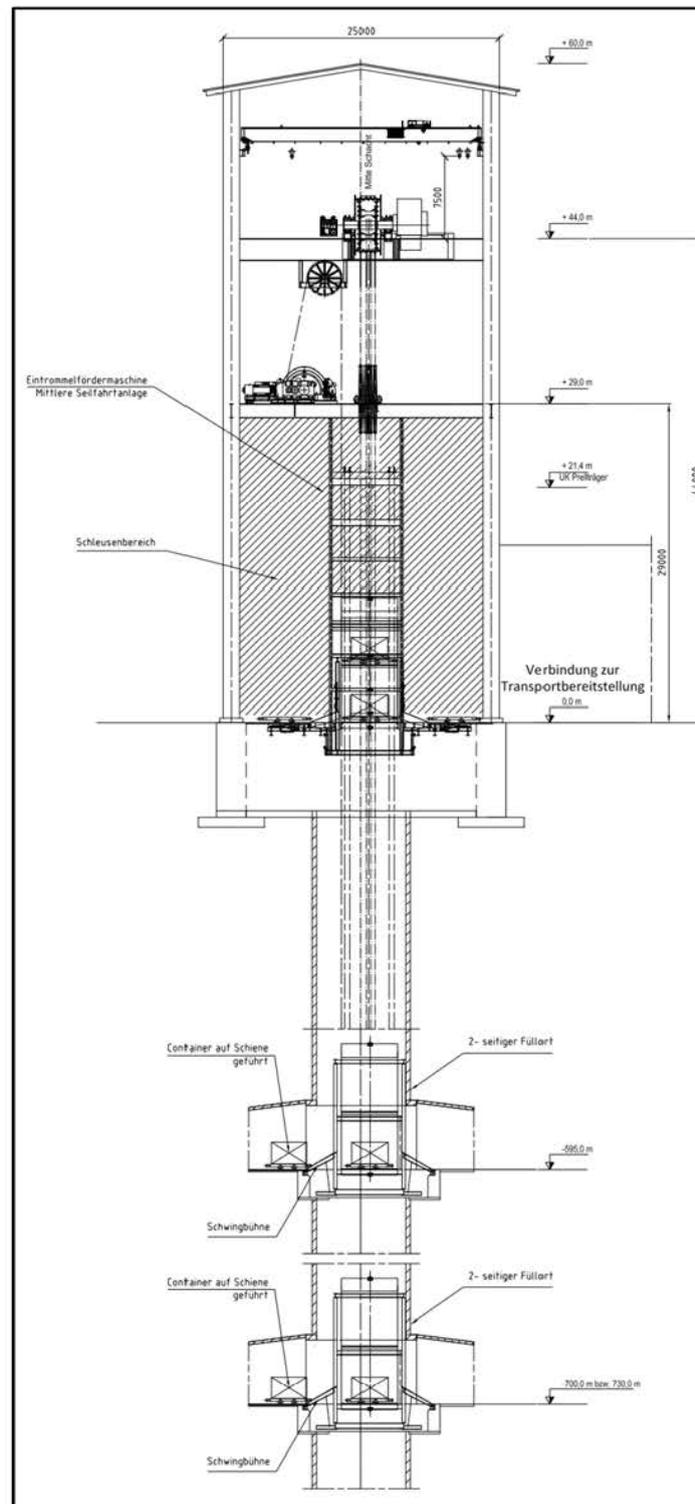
Schachtförderanlage im Längsschnitt mit Unterdruckbereich
